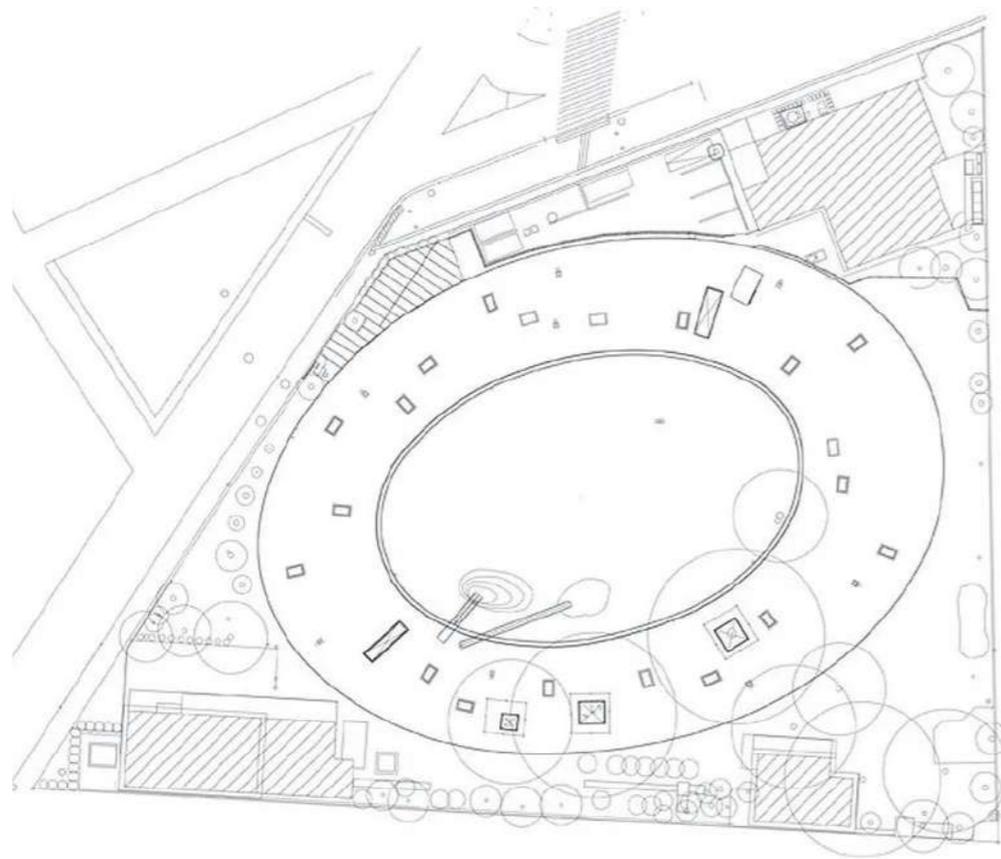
Plano cubierta más entorno. Fuente: <http://www.tezuka-arch.com/works/education/fujjyochien/>
